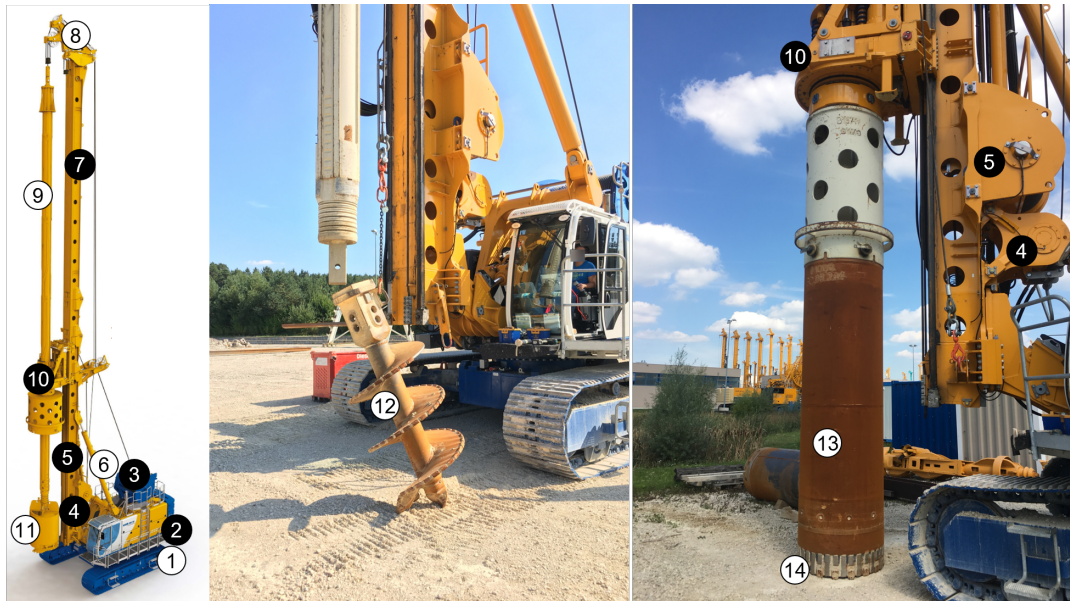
Beispielhaftes Bohrgerät zur Darstellung relevanter Bauteilkomponenten (weiß ausgefüllte Markierungen) und Sensoren zur Datensammlung (schwarz ausgefüllte Markierungen): (1) Unterwagen; (2) Oberwagen (Pumpendrucke); (3) Hauptwinde (Seilkraft, Geschwindigkeit und Werkzeutiefe); (4) Hilfswinde (Seilkraft); (5) Versorgungswinde (Seilkraft); (6) Kinematik; (7) Mäkler bzw. Mast (Mastneigung); (8) Mastkopf; (9) Kellystange; (10) Kraftdrehkopf (Drehmoment, Geschwindigkeit); (11) Kastenbohrer; (12) Schneckenbohrer; (13) Verrohrung; (14) Bohrschuh (Bildrechte links: Bauer AG [BAU-2023], mittig und rechts: eigene Bilder und Darstellung nach [Fis-2021d; Fis-2023a])
